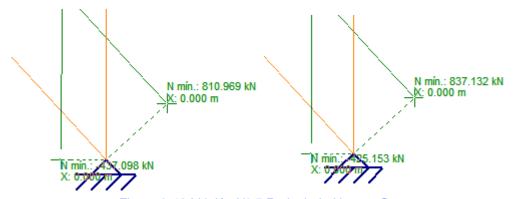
| Unión N° 5 Reticulado Norte – Sur.
